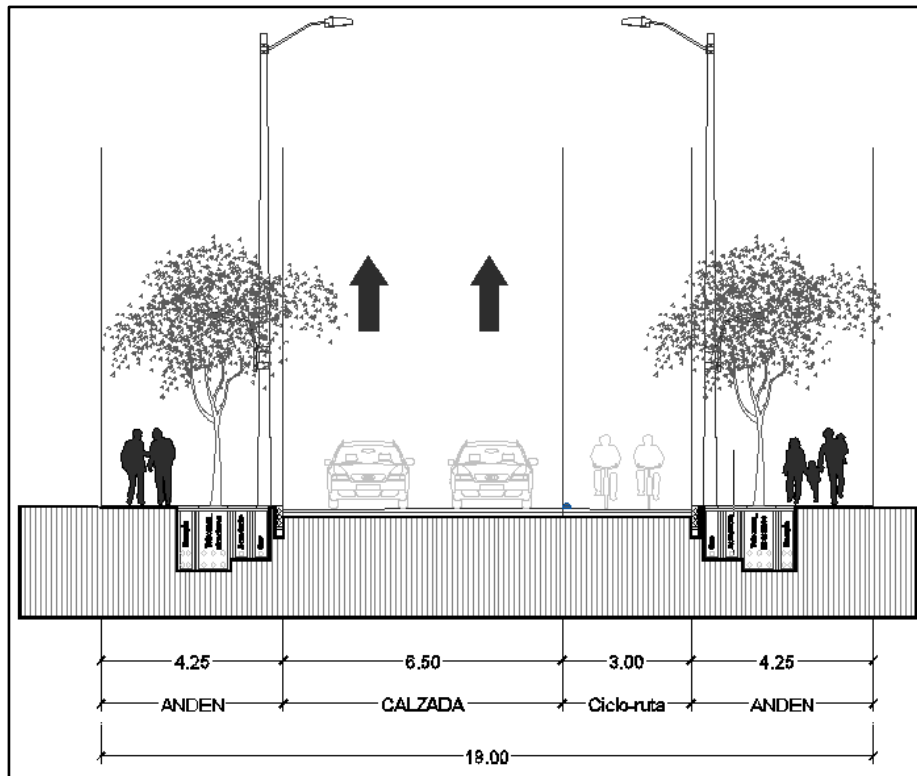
Perfil típico vía tipo V5 (Carrera 16)
